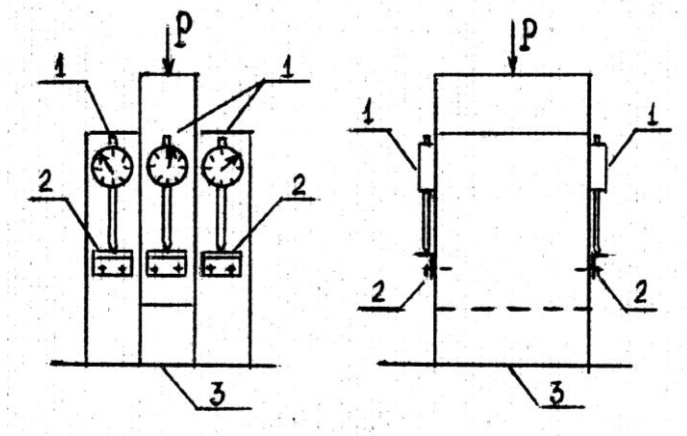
Схема приложения нагрузки и размещения измерительных приборов: 1 – индикаторы (мессуры); 2 – уголки для упора штифта индикаторов; 3 – траверса машины.
